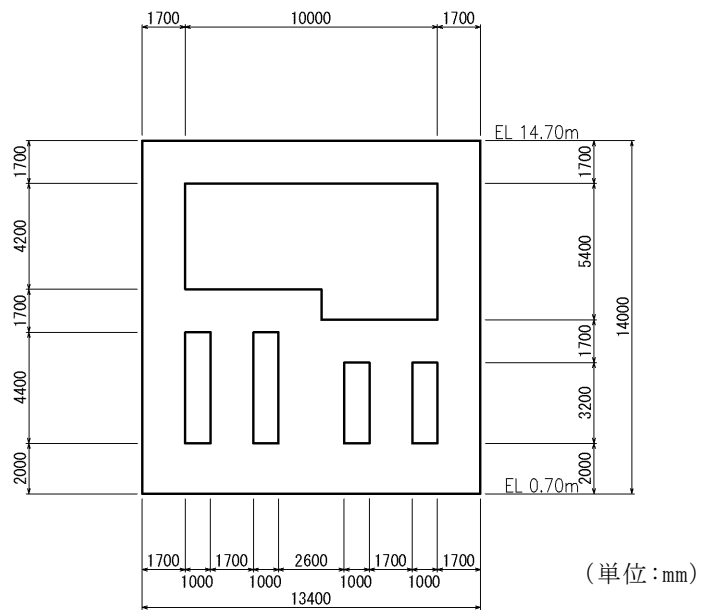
第 1 ベントフィルタ格納槽 断面図 (B-B 断面)
